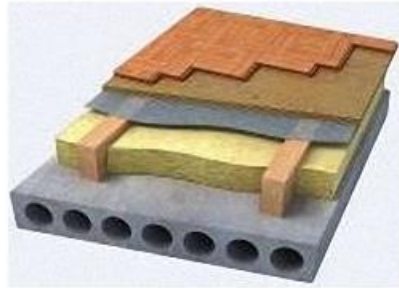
Схема утепления перекрытия по железобетонным плитам (между лагами)
